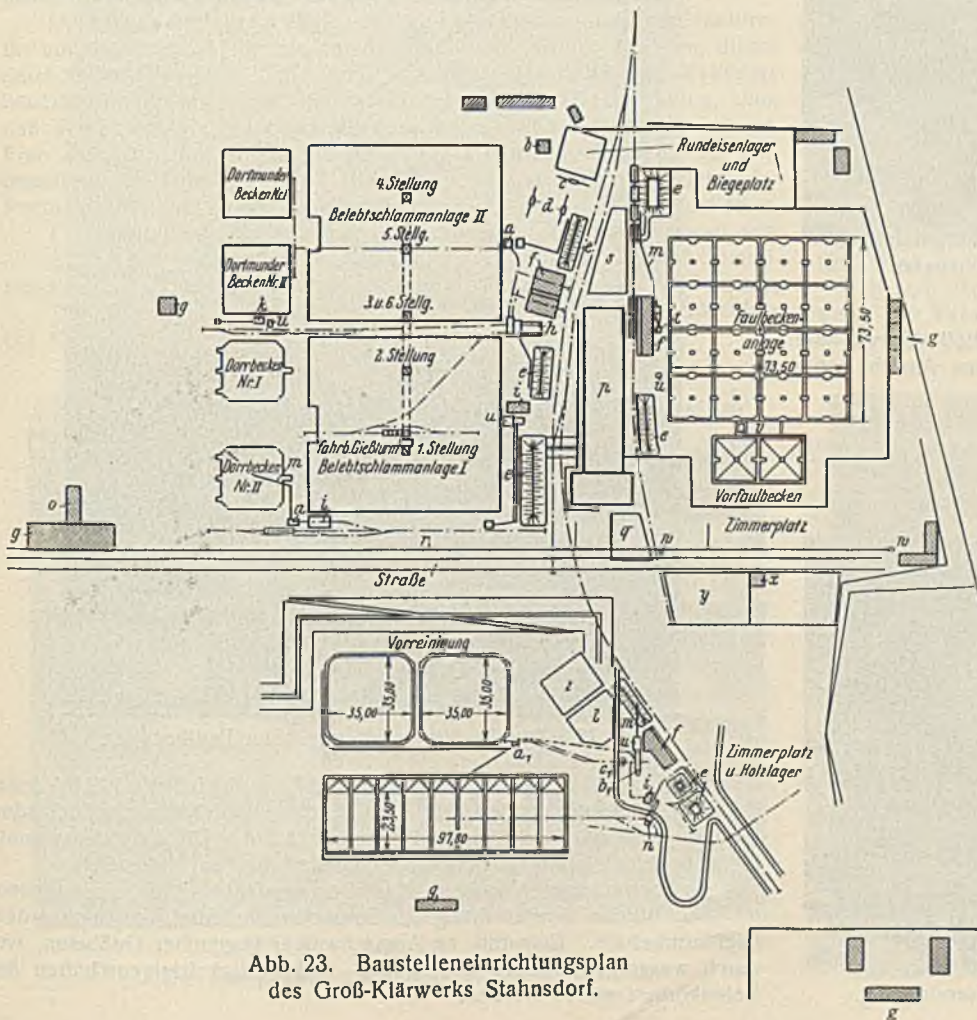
Baustelleneinrichtungsplan des Groß-Klärwerks Stahnsdorf.
